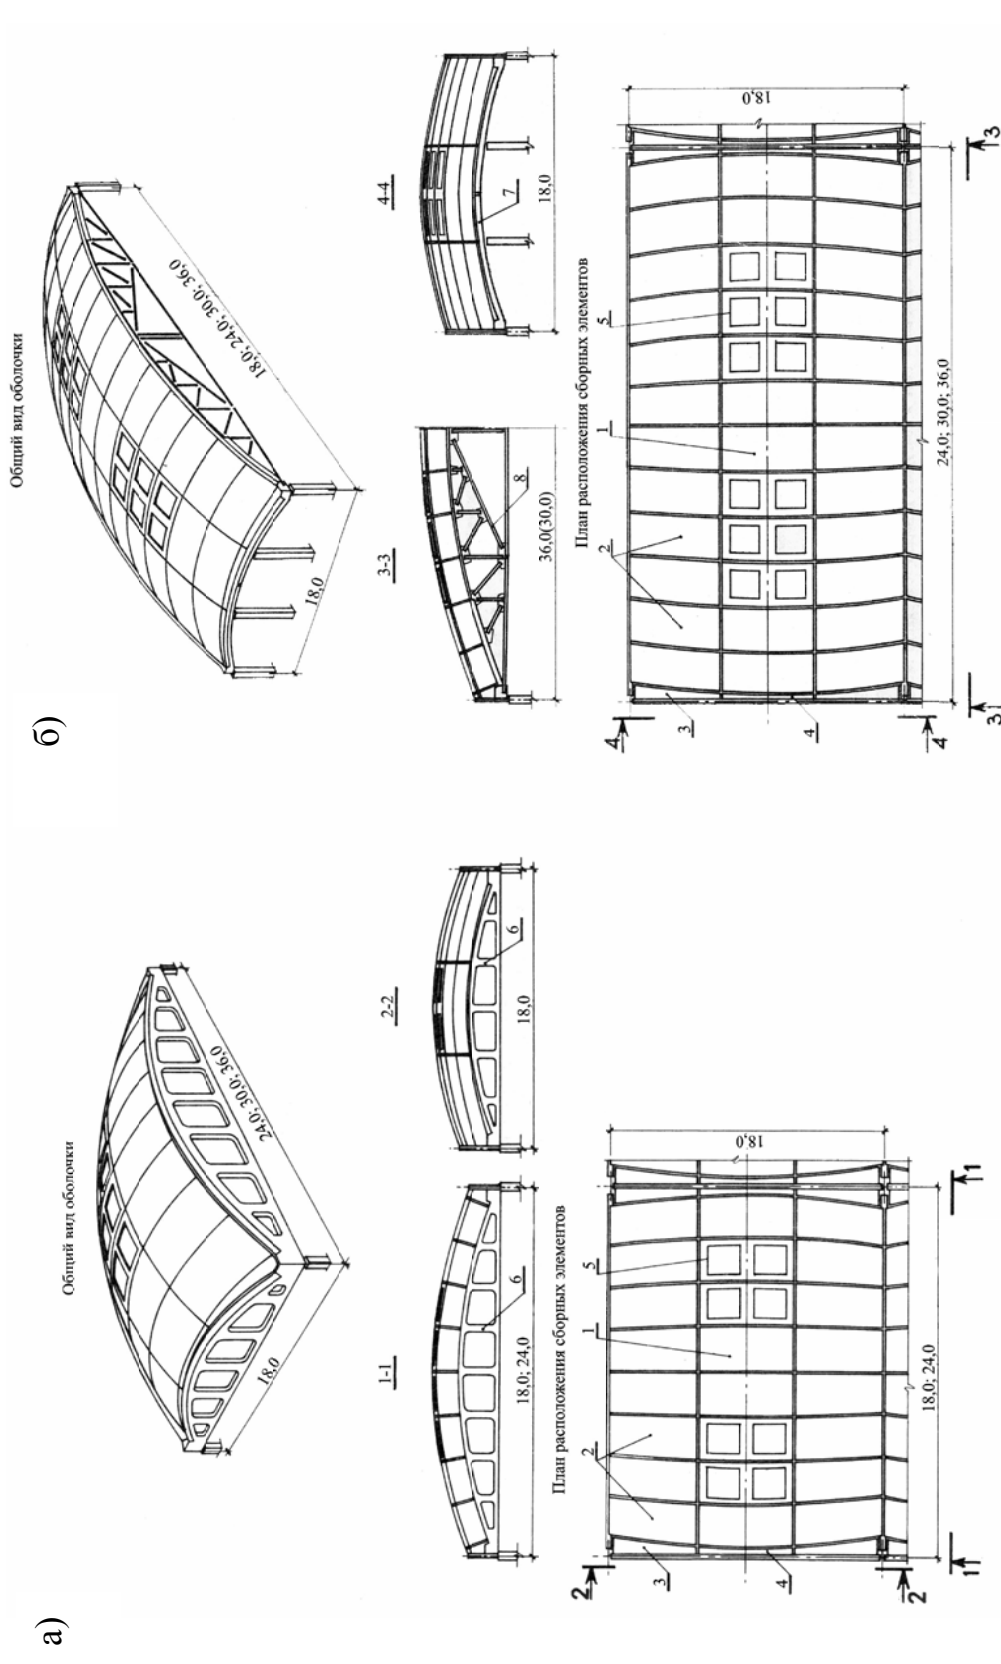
Железобетонные многоволновые оболочки положительной кривизны:
